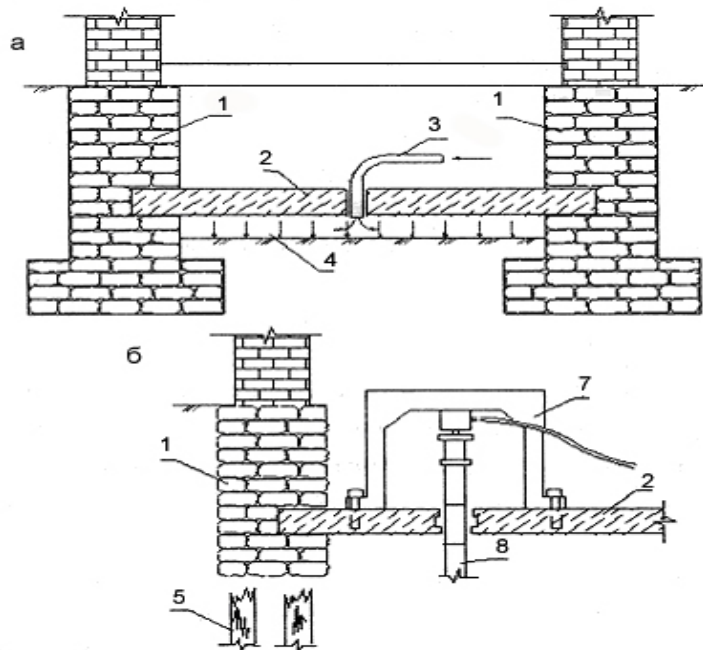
Збільшення опорної площі за допомогою монолітної залізобетонної плити: *а* – з обпресуванням ґрунту; *б* – з підведенням багатосекційних паль вдавлювання; *1* – існуючий фундамент; *2* – залізобетонна плита; *3* – труба для ін'єкції розширювального цементного розчину; *4* – цементний розчин між плитою та ґрунтом; *5* – згнилі дерев'яні палі; *6* – домкрат; *7* – опорне коромисло; *8* – вдавлювані палі
